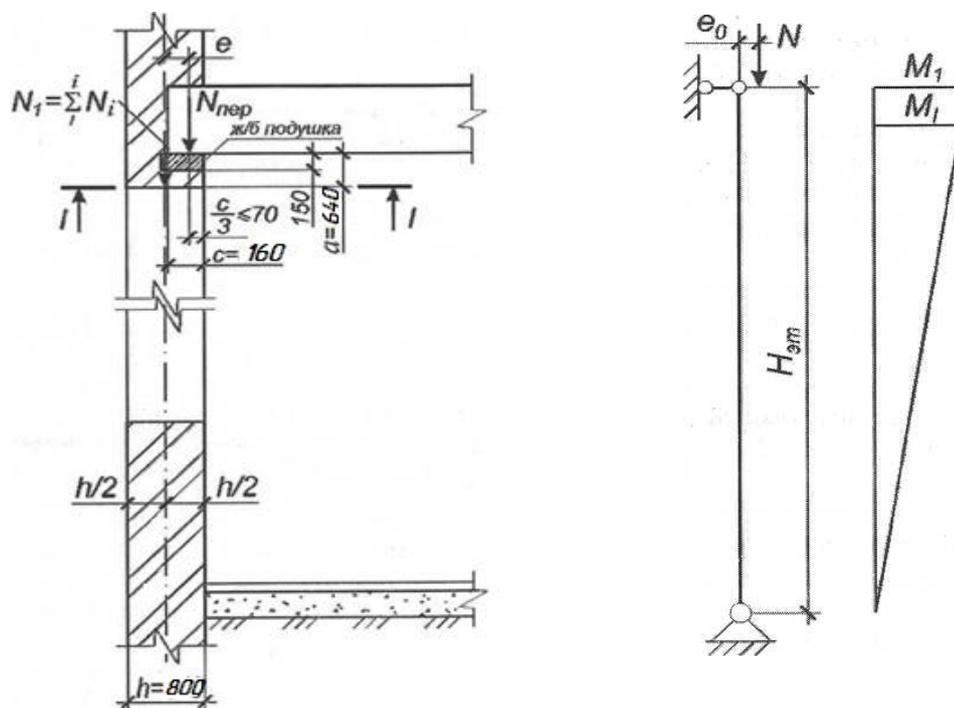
К определению расчетных усилий в сечении I-I простенка
